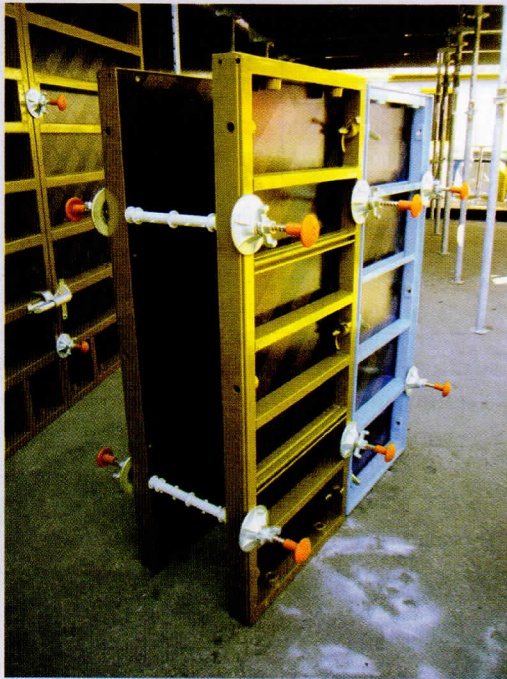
Pannelli prefabbricati per la cassetta di un getto.
